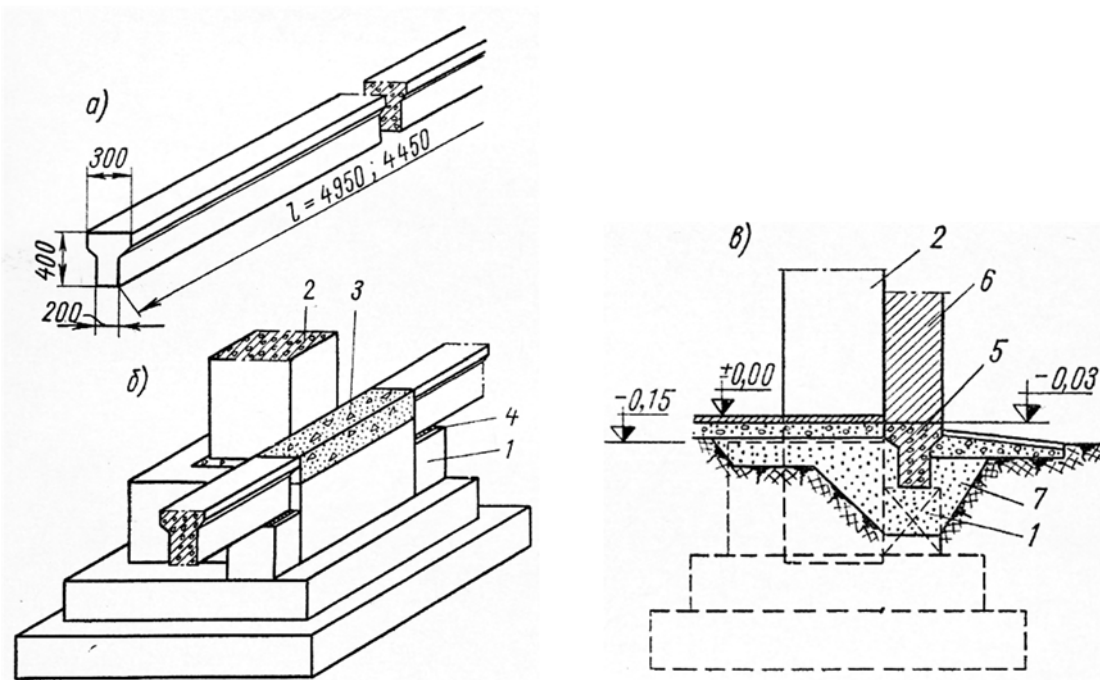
Сборный железобетонный фундамент и фундаментные балки:
